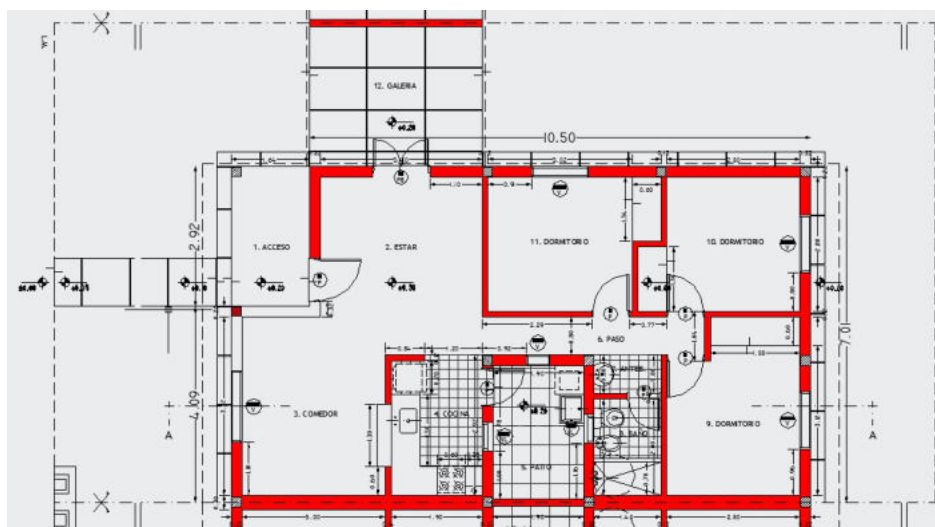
Planta de arquitectura de la vivienda – Fuente: Planimetría provista por el propietario
